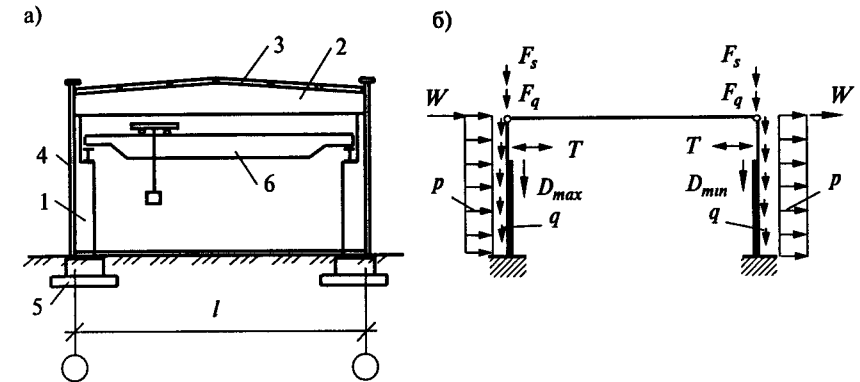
Поперечная рама одноэтажного производственного здания: а) конструктивная схема; б) расчетная схема рамы; 1 — колонны; 2 — стропильная балка; 3 — плита перекрытия; 4 — стенная панель; 5 — фундамент; 6 — мостовой кран с крановой тележкой
